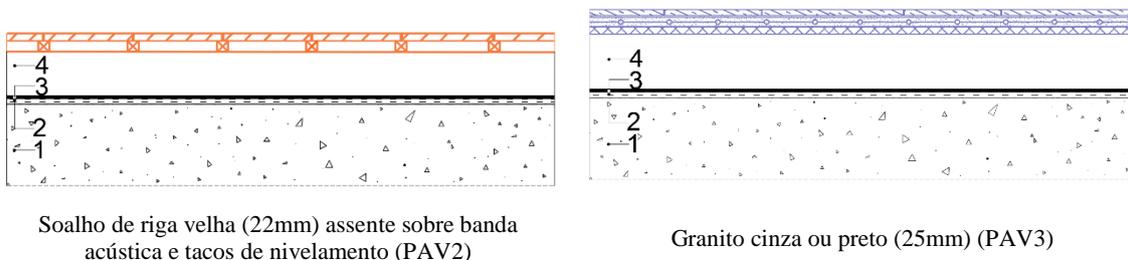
Composição dos pavimentos PAV2 e PAV3.
